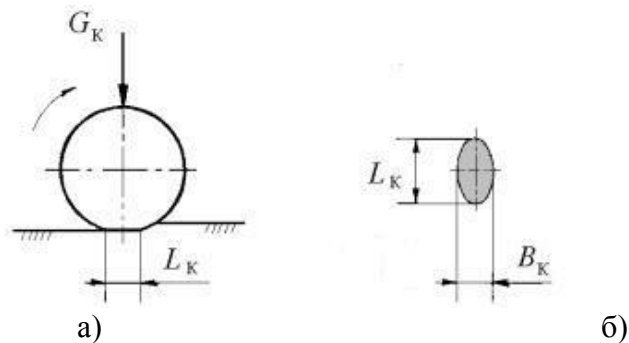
Формування колії котком: а – повздовжній перетин котка; б – опорна площадка котка, G_k – сила ваги котка, H ; L_k – довжина опорної площадки котка, м; B_k – ширина опорної площадки котка, м
